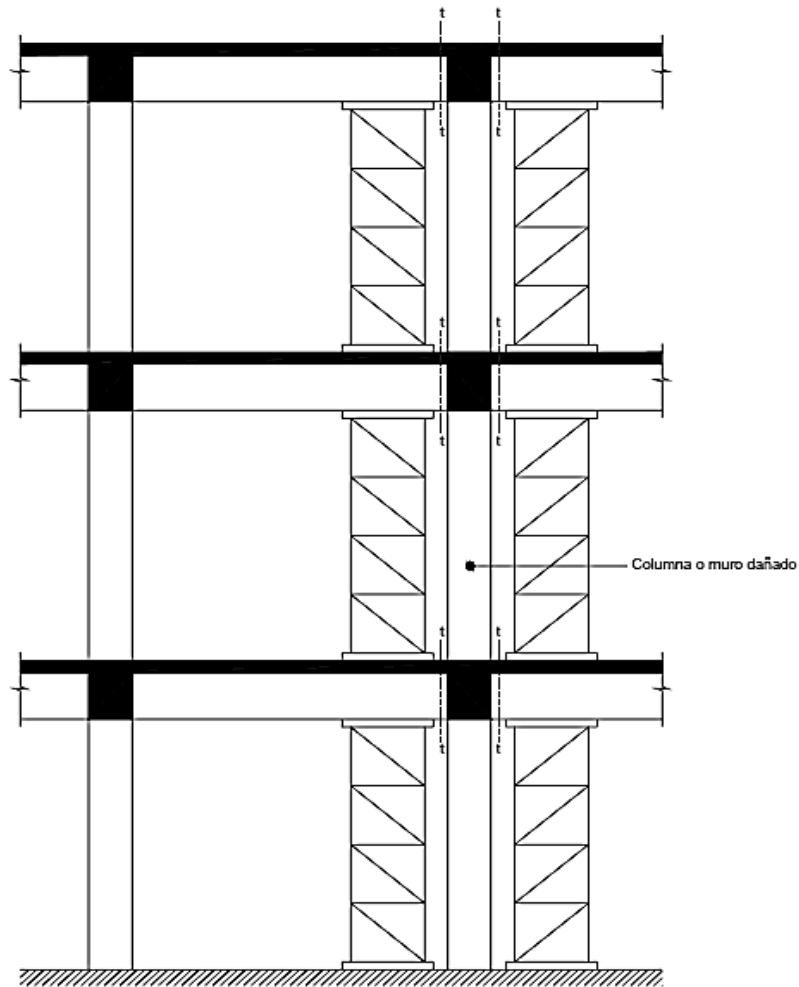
Apuntalamiento hacia la cimentación o primer piso de columna vertical.
